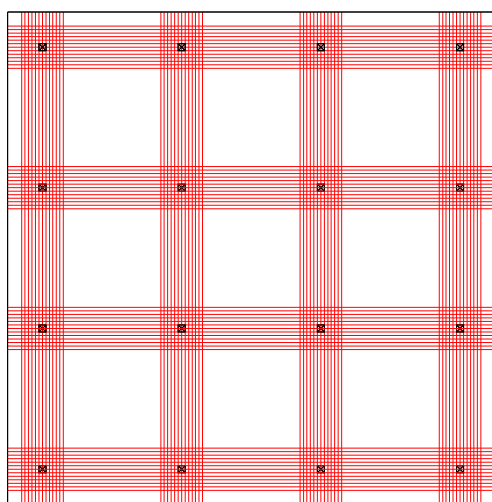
Alternativa de traçado 2 dos cabos no pavimento com balanço
